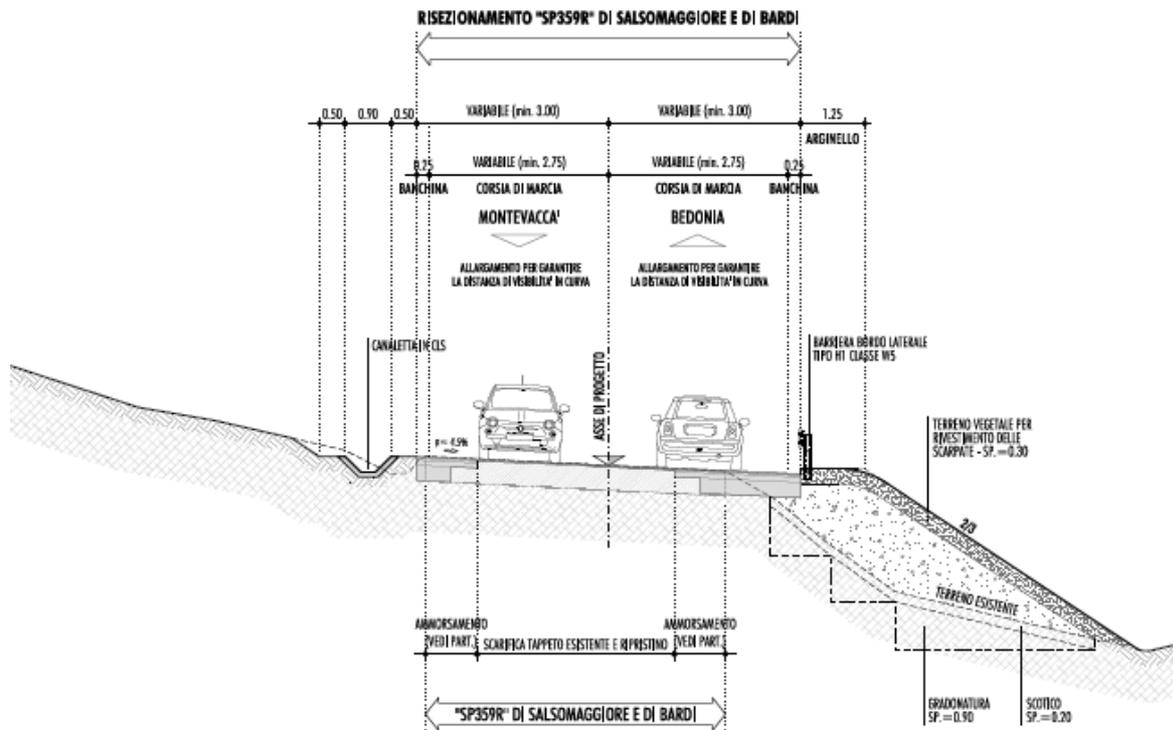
SEZIONE TIPO TRATTO 1 CON AMPLIAMENTO RILEVATO
